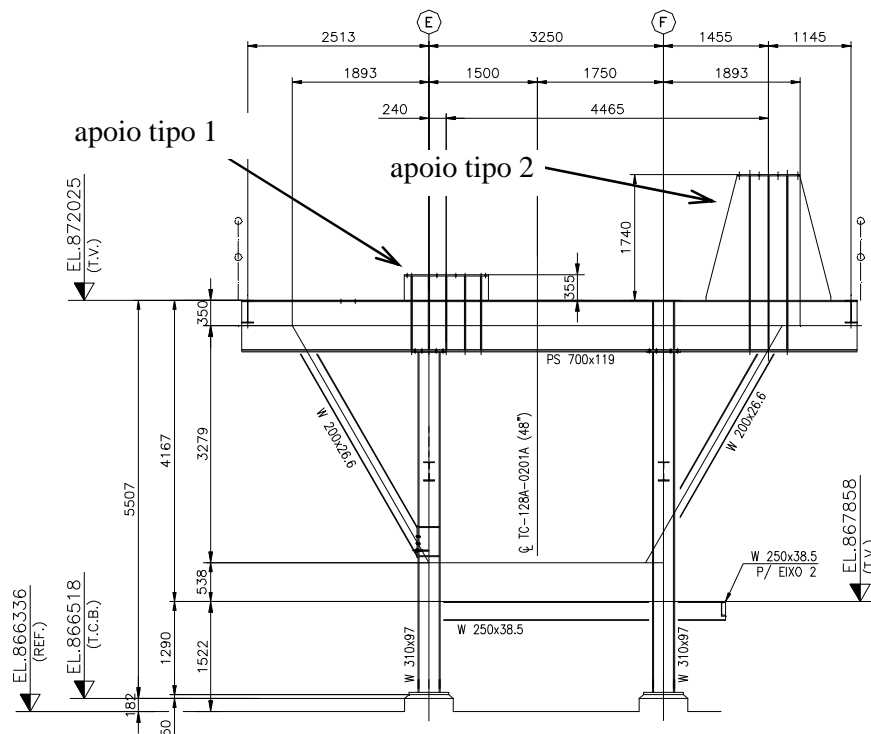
Apoios da peneira na elevação dos eixos 2 e 4.
